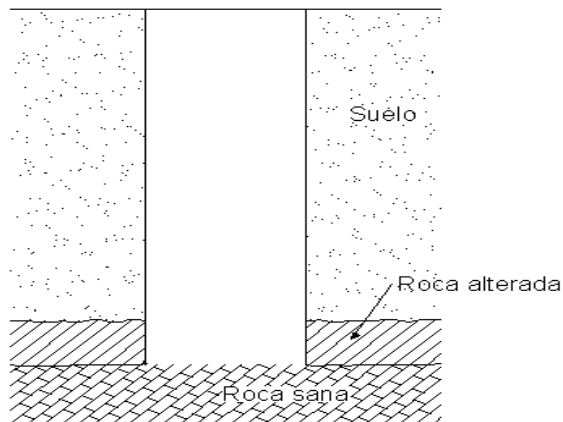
Pilar barrenado sobre roca (pilar en pozo)
